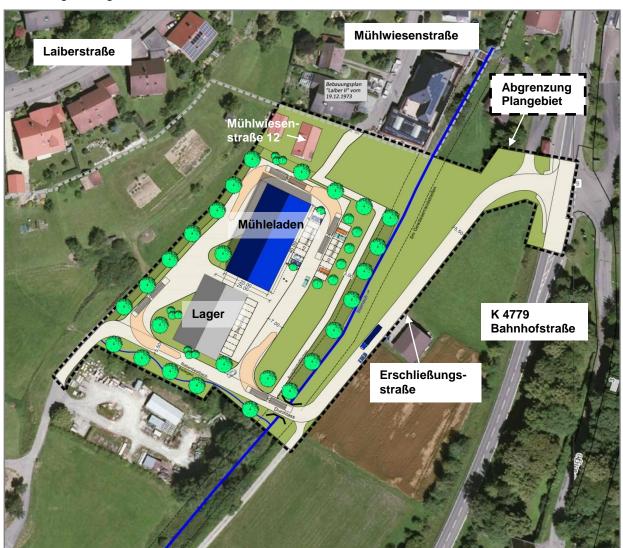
Lage des Plangebiets mit vorgesehener Bebauung (Nachbarschaftsladen) und Lager /15/
